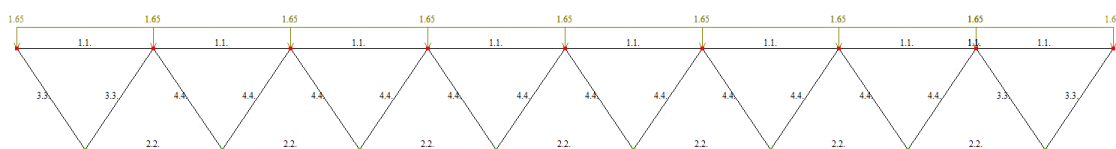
Загрузка фермы снеговой нагрузкой
